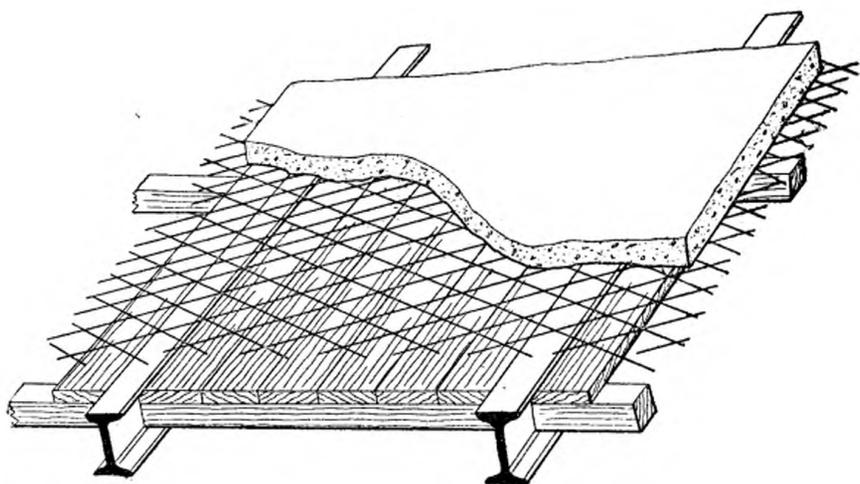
Armature en métal déployé posée sur cintre et recouverte en partie du plancher en béton.
